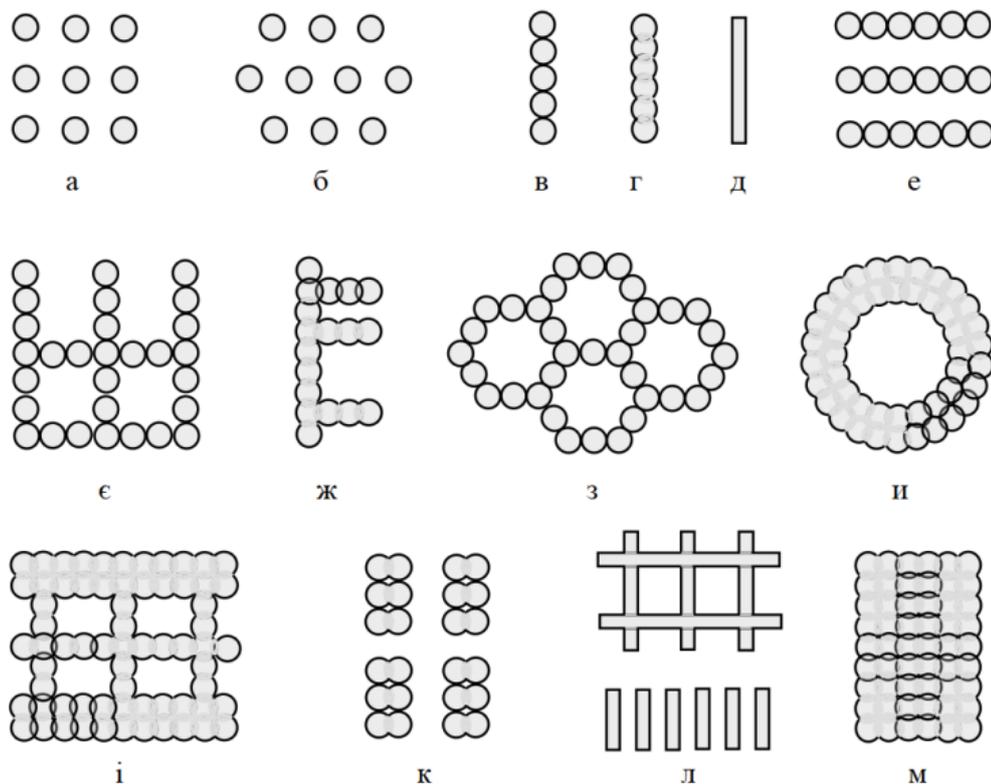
Основні схеми армування у плані за М. Торолніскі: а, б – окремі елементи (квадратне та трикутне розташування), в – дотична стіна в ґрунті, г – перехресна стіна в ґрунті, д – траншея, е – дотичні стіни в ґрунті, є – сітка, ж – перехресна стіна з контрфорсами, з – дотичні клітини, и – кільце, і – решітка, к – групові колони, л – система траншей, м – блок
